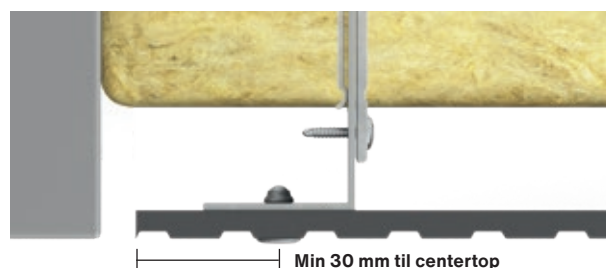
Installation af Swisspearl Patina Inline tilskåret plade.
